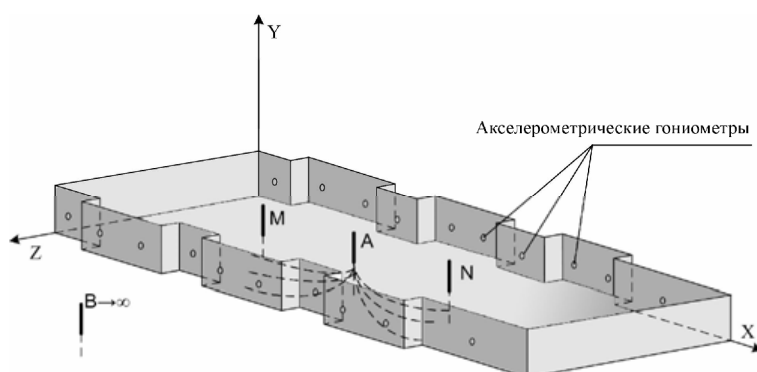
Схема размещения системы измерения неравномерности осадок фундамента
